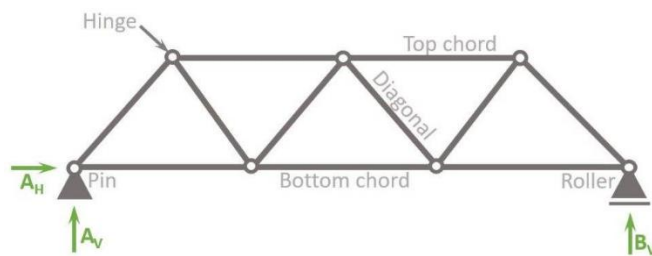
Estructura articulada tipo Warren. Fuente: <https://www.structuralbasics.com/warren-truss/>
